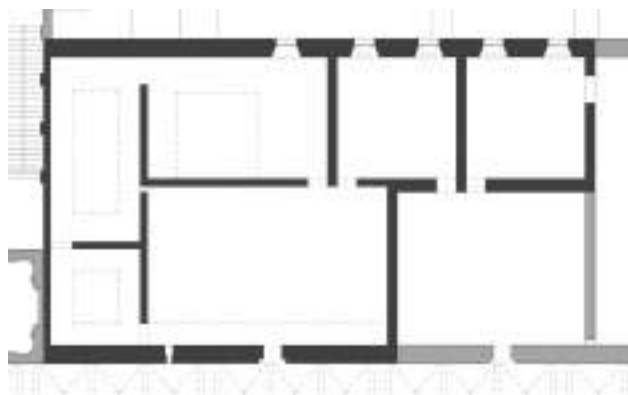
Planimetria del progetto realizzato dove si possono notare la posizione e la forma dei lucernai. Disegno di Ilaria Cattabriga.
